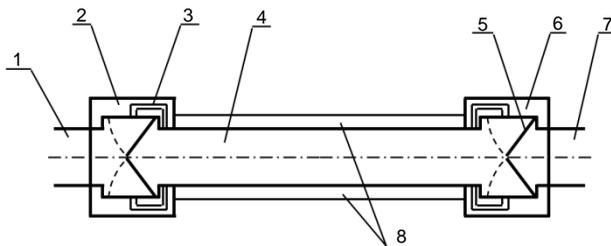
Принципиальная схема плана камеры шлюза:
